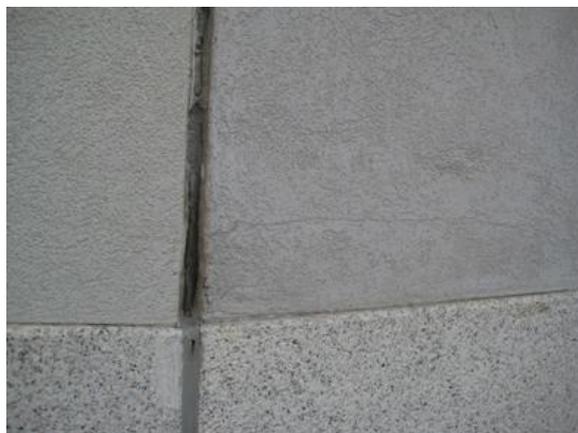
Fissuração nas imediações de juntas de dilatação [16]
